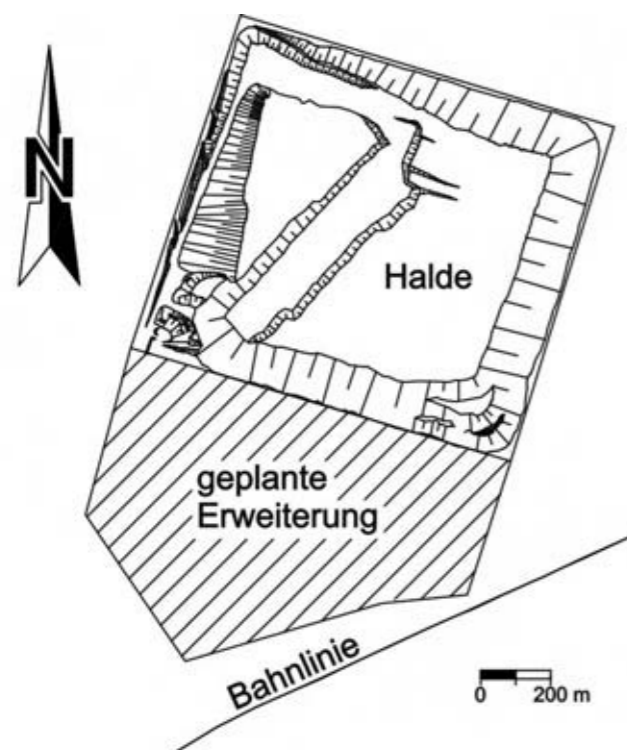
Lageplan der Halde mit Erweiterungsfläche und Bahnlinie / Site plan of an existing tailings heap with enlargement area and railway line
